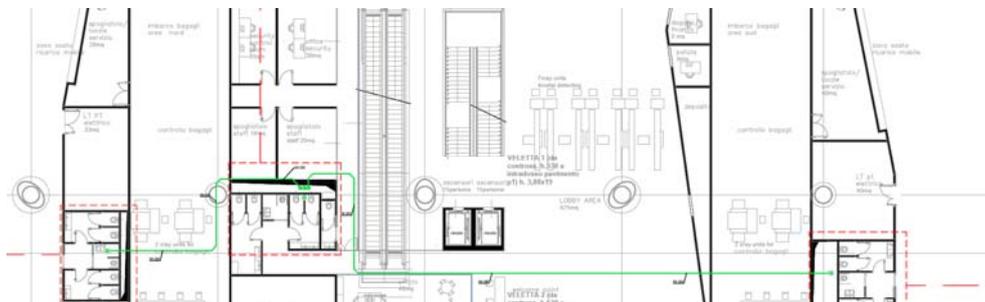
Edificio Terminal, piano terra: Impianto estrazione aria servizi igienici
